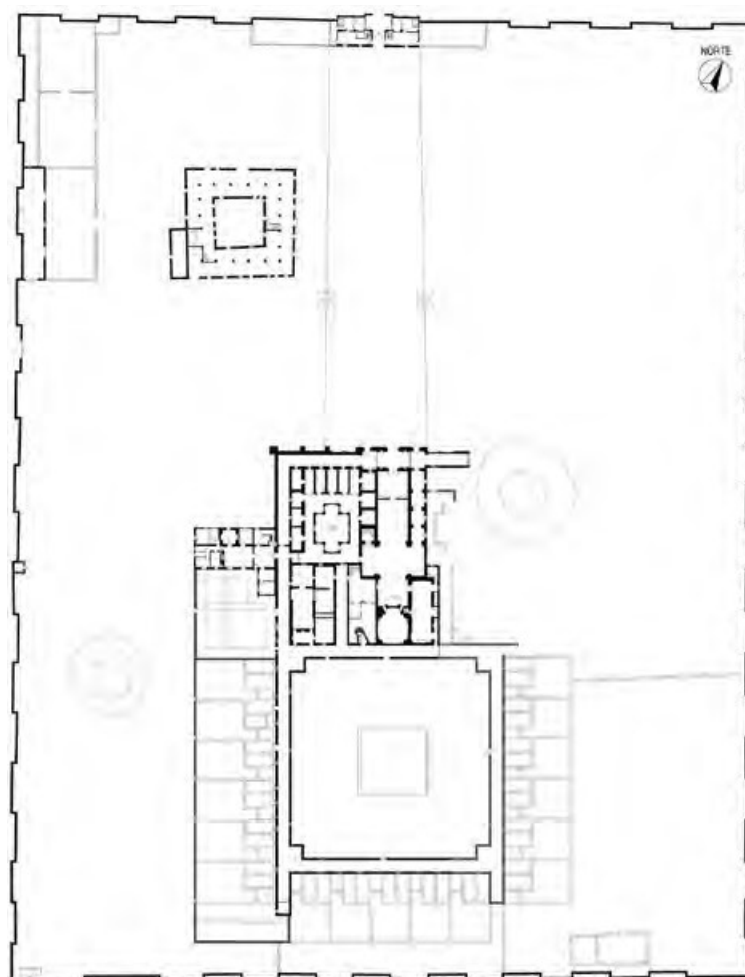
Planta general de estado actual. Fuente: elaboración propia.
